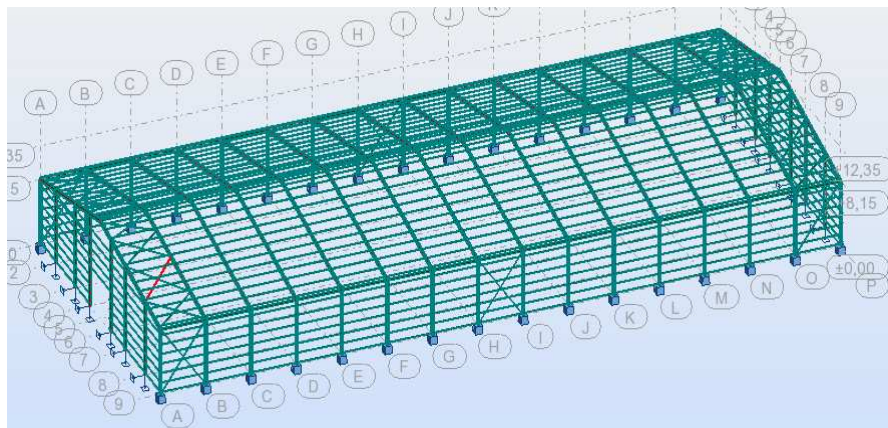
La diagonale la plus sollicité de la poutre au vent.
